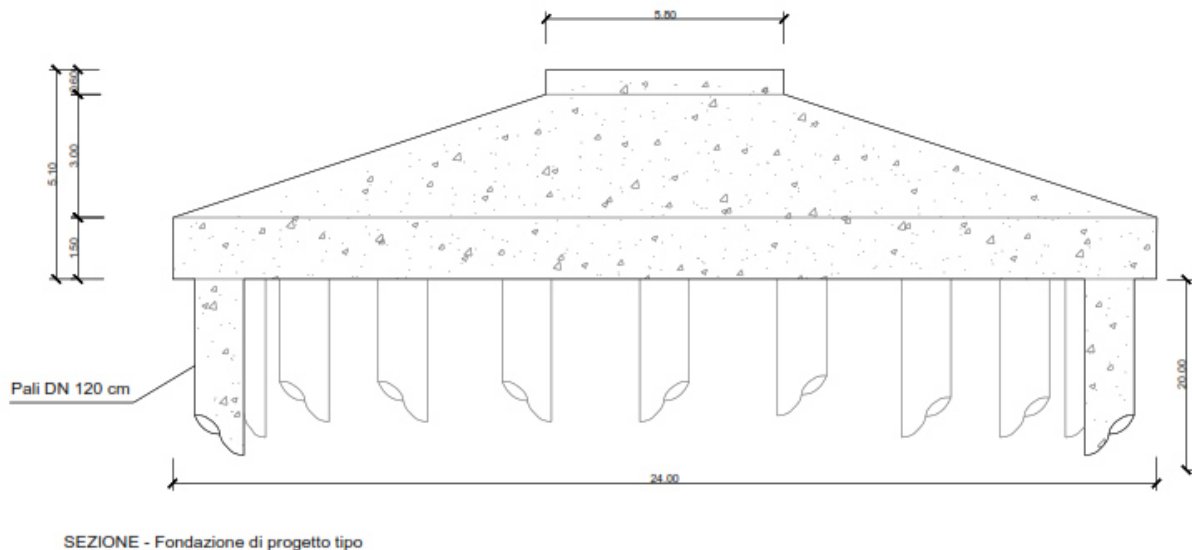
Schema del plinto di fondazione dell'aerogeneratore
